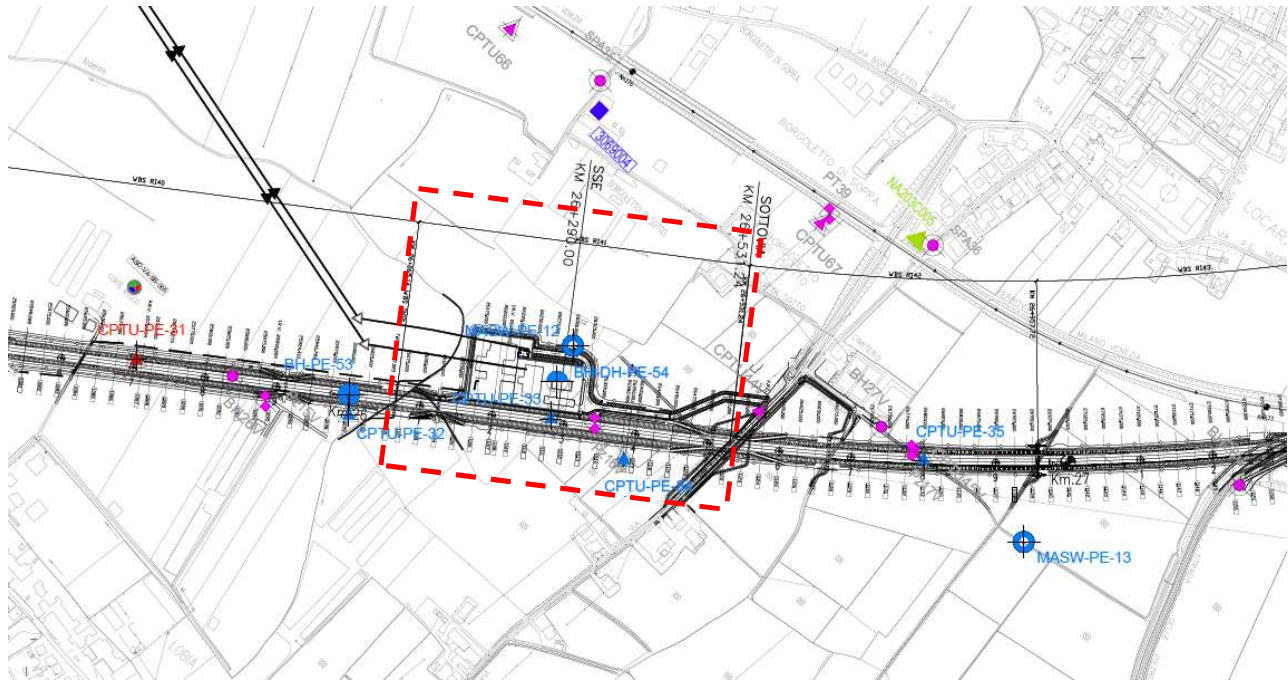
Planimetria Rilevato R41, estratto dalla Planimetria Generale (Doc. Rif.[6])
